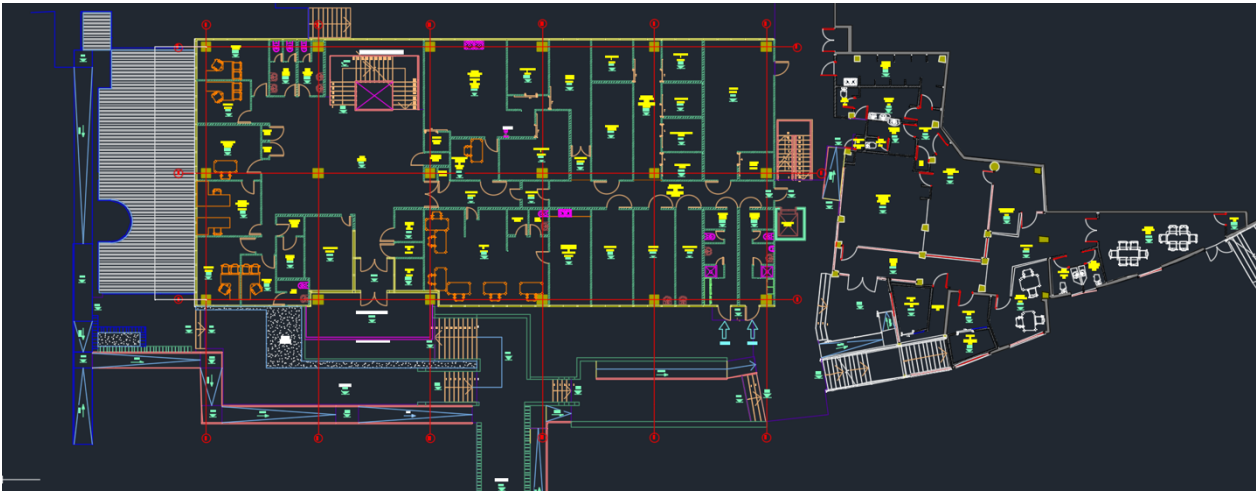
"Planimetria Nivel 1 Facultad Farmacia de UV"
